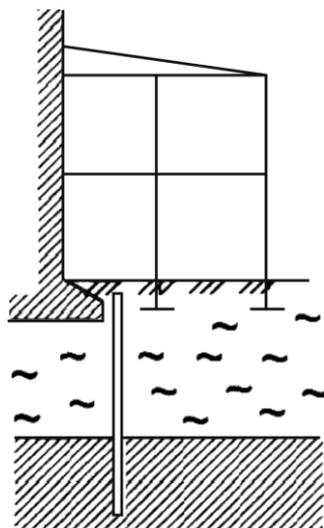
Устройство шпунтовой стенки для предотвращения деформаций существующего здания
